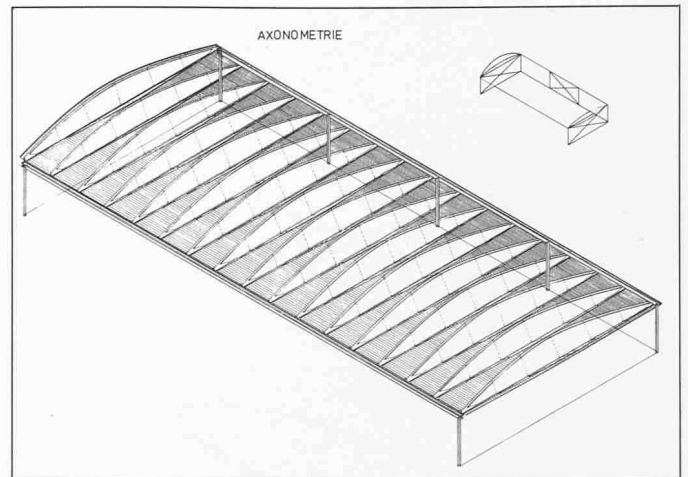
Die Dachkonstruktion ermöglicht grosse seitliche Öffnungen
